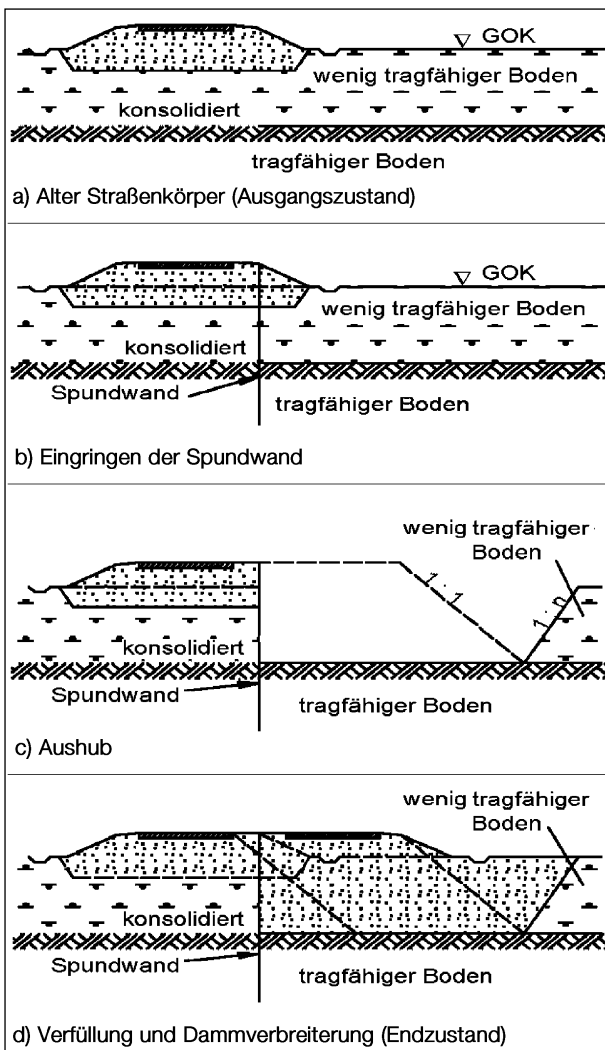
Einseitige Verbreiterung mit vollständigem Bodenaushub im Schutze eines Spundwandverbaues
